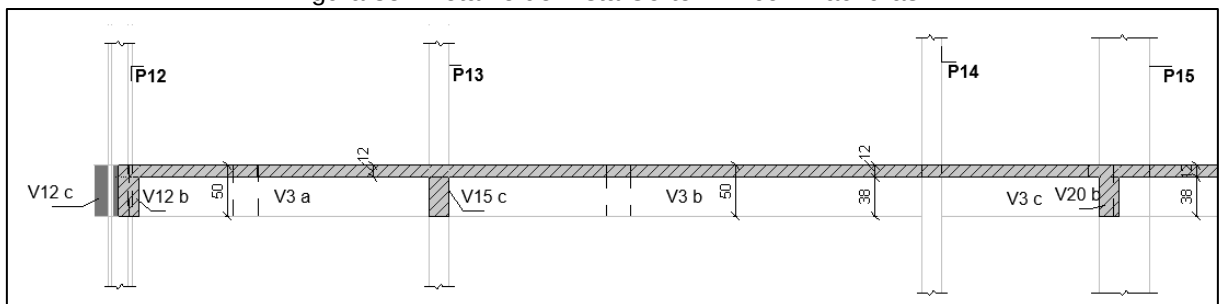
Vista Corte A-A gerada automaticamente dos elementos em seção.
